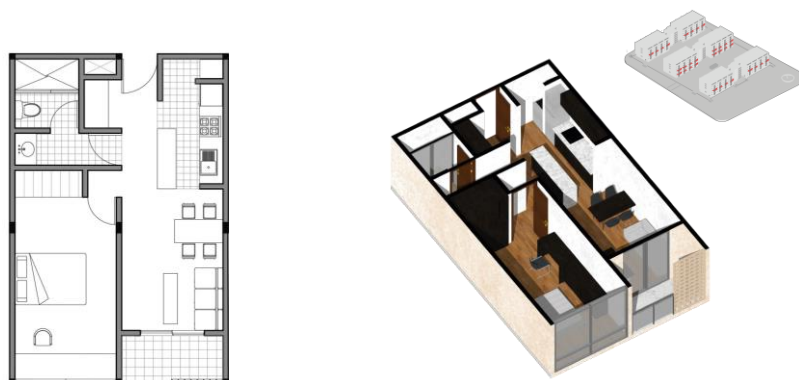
Imagen 9:* se muestran los planos, axonometría, y localización de la tipología 2
